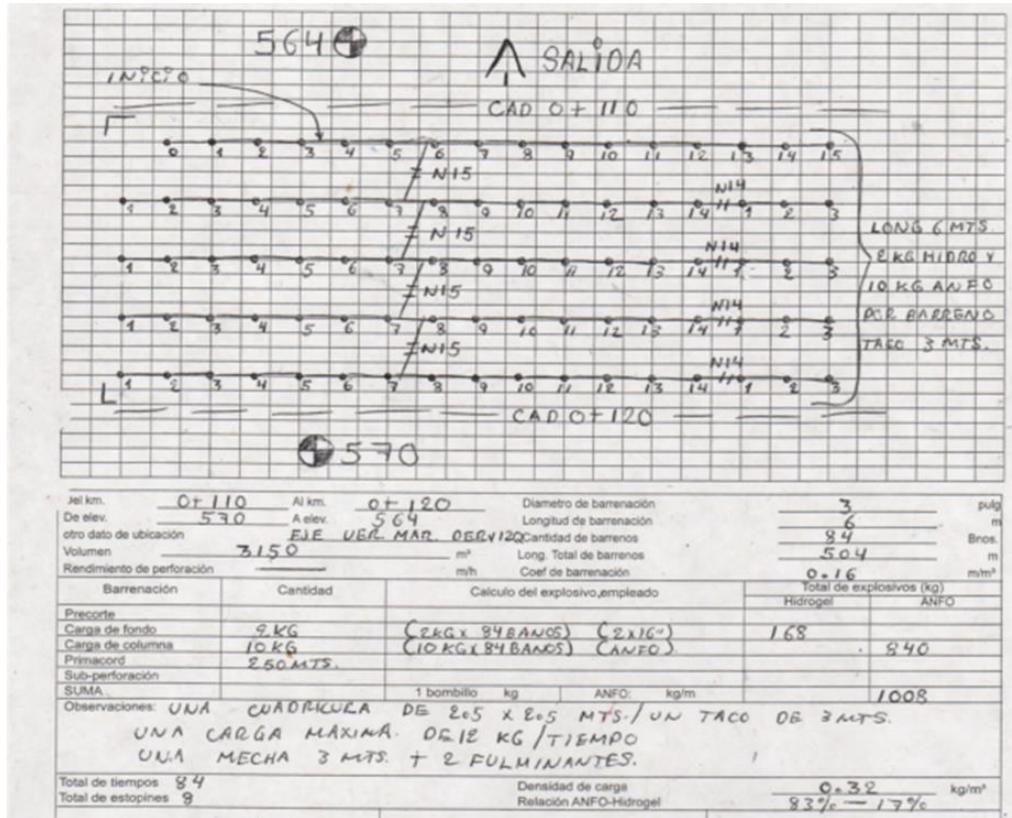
Plantilla de cálculo (barrenación y voladura). Proporciona la cantidad exacta de explosivo a utilizar por trueno.
